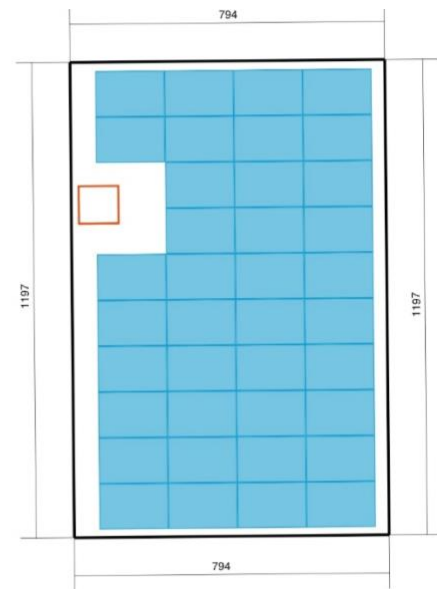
Zürcherstrasse 90.1, Belegungsplan, Dachfläche 1
